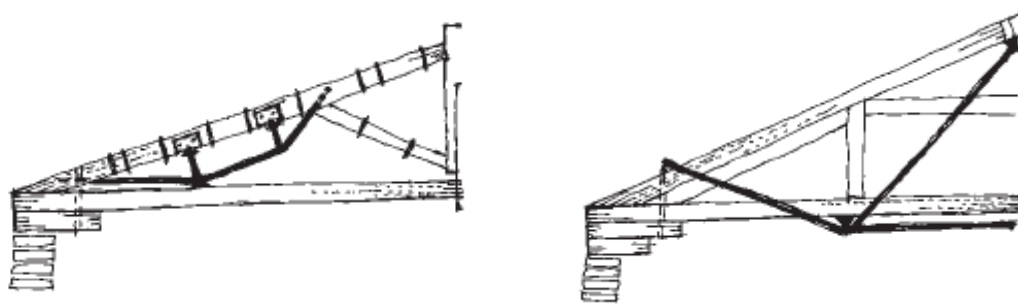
, 84 : Le renforcement de la structure en bois des toitures par des armatures post-contraintes.
